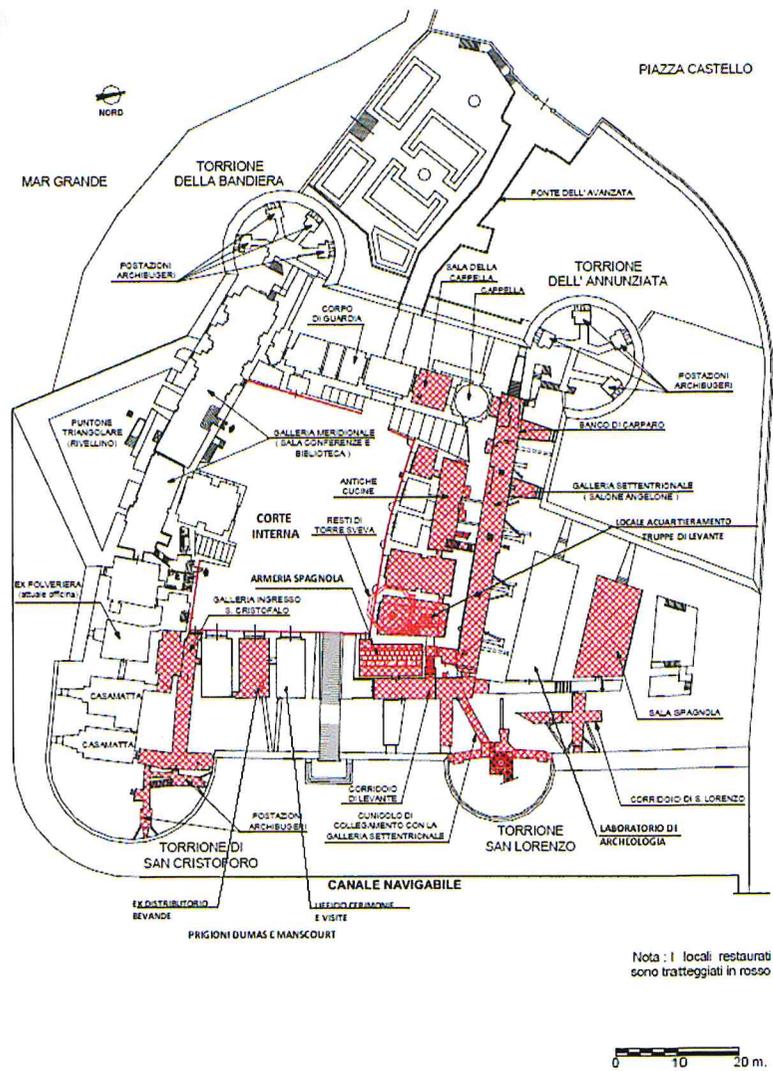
Planimetria attuale del piano della corte interna del Castello.
